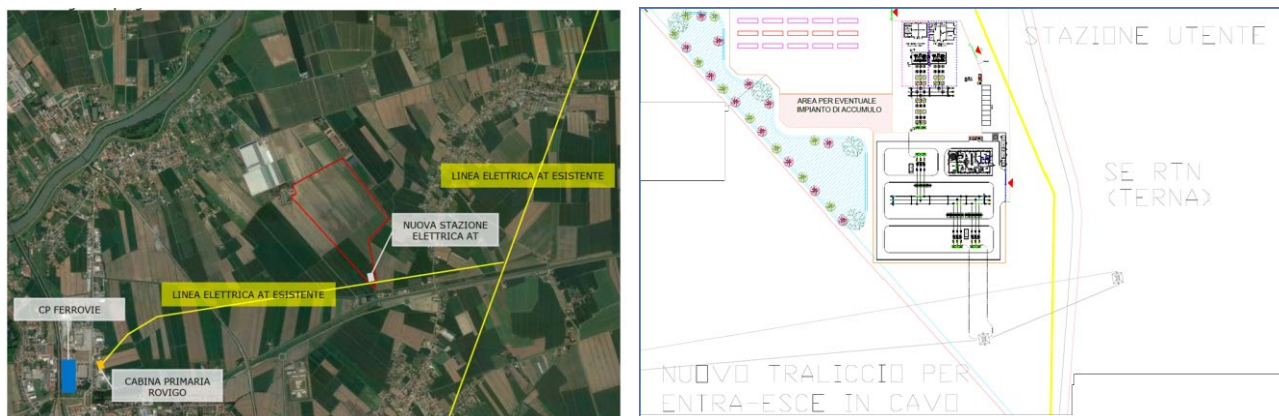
Planimetria (sx) e dettaglio (dx) della rete di connessione tra la stazione MT/AT e la stazione AT di TERNA (pag 148 SIA)
